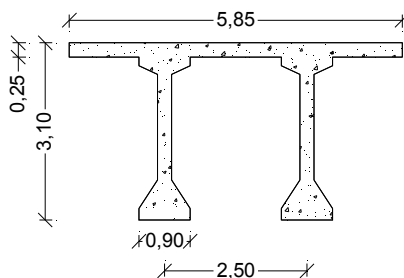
Seção transversal típica do tabuleiro do vão em Concreto Protendido.
